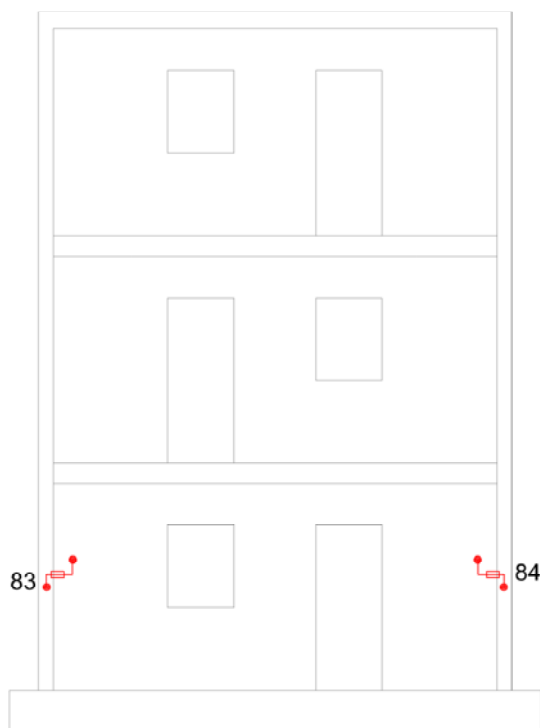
Strumentazione tradizionale sulla parete n. 4, lato interno.
